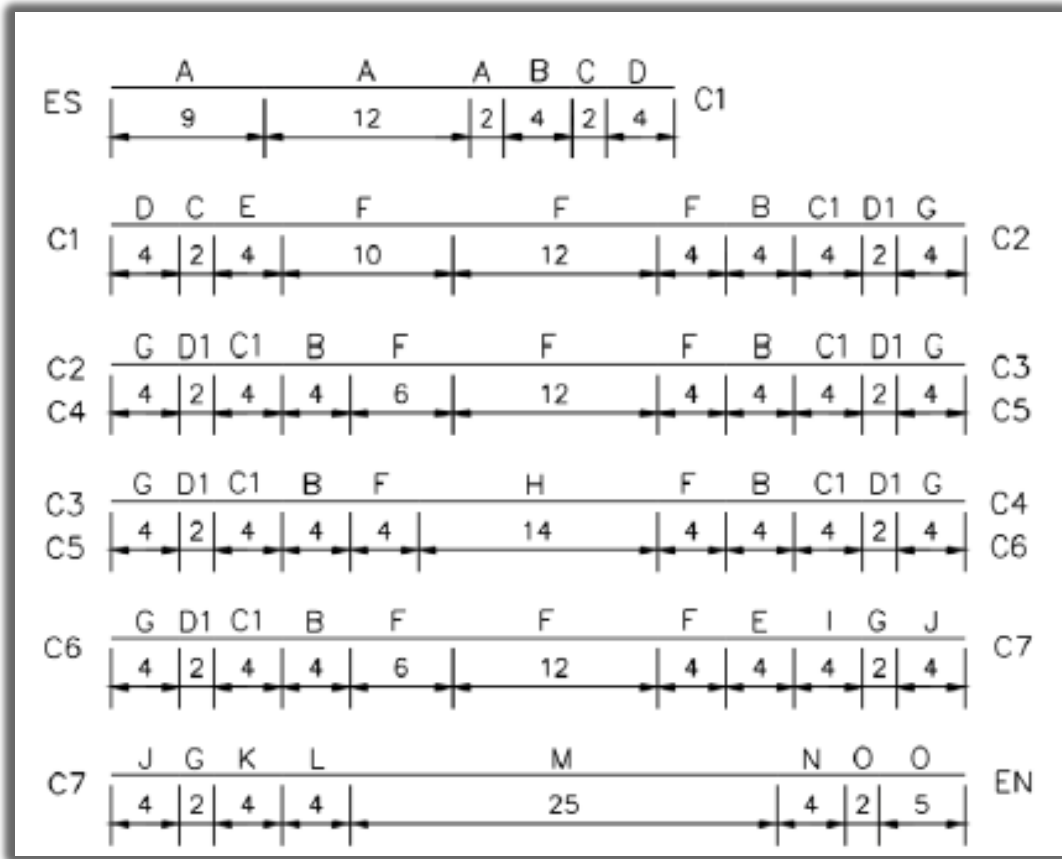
Distribución secciones de viga del viaducto El Salto, dimensiones en [m] (Daza, 2003)
